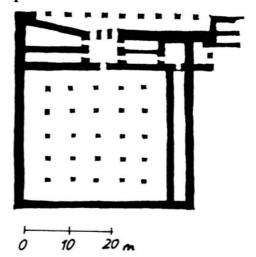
Plan d'une salle hypostyle (Büyükkale, bâtiment D, d'après Bittel, 1970, fig. 22 B).
